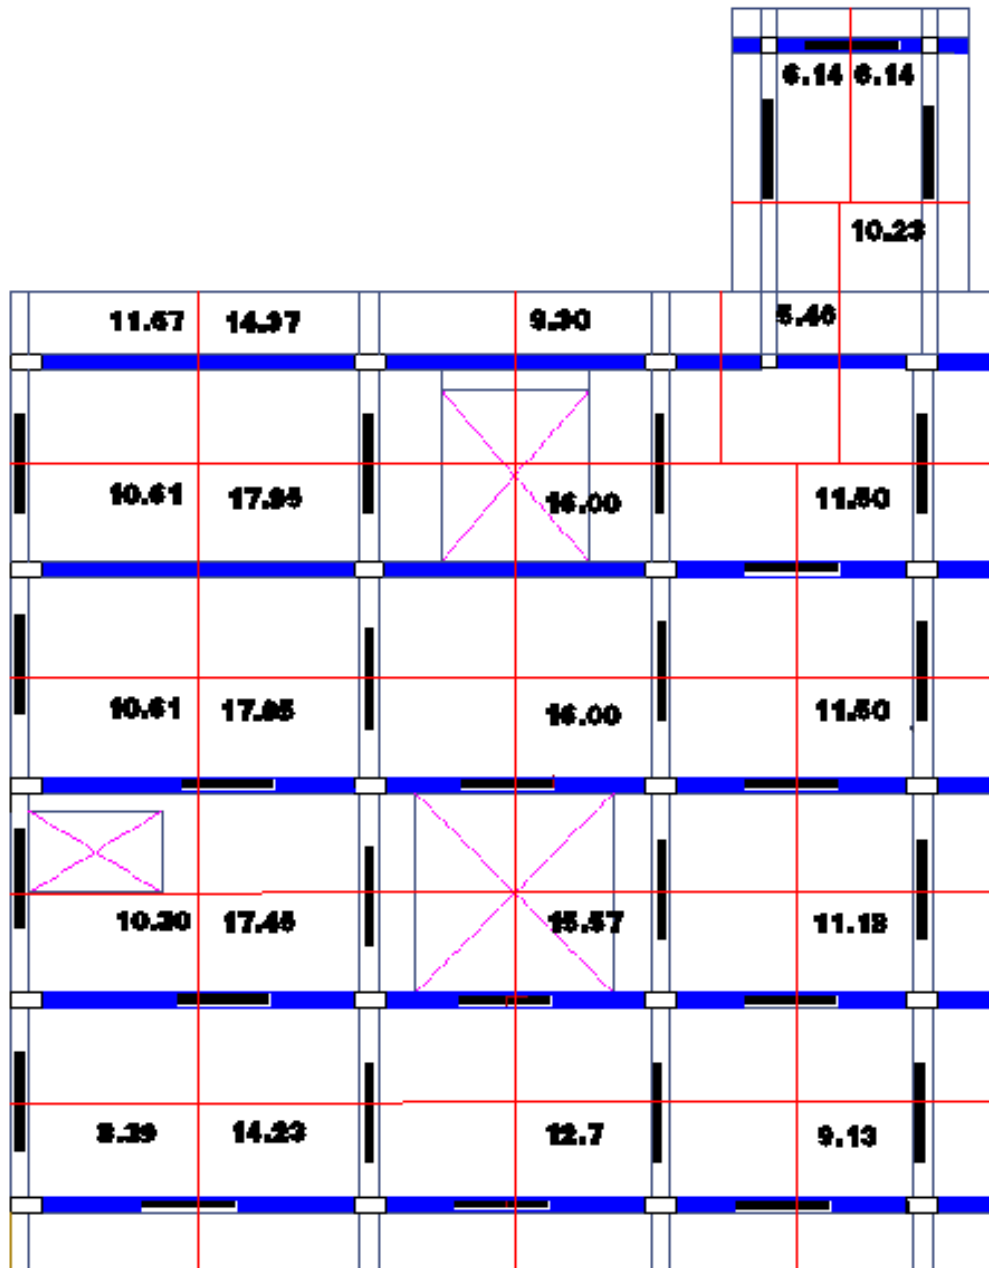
Ubicación en planta y área de tributaria de Columnas – Primer Piso
